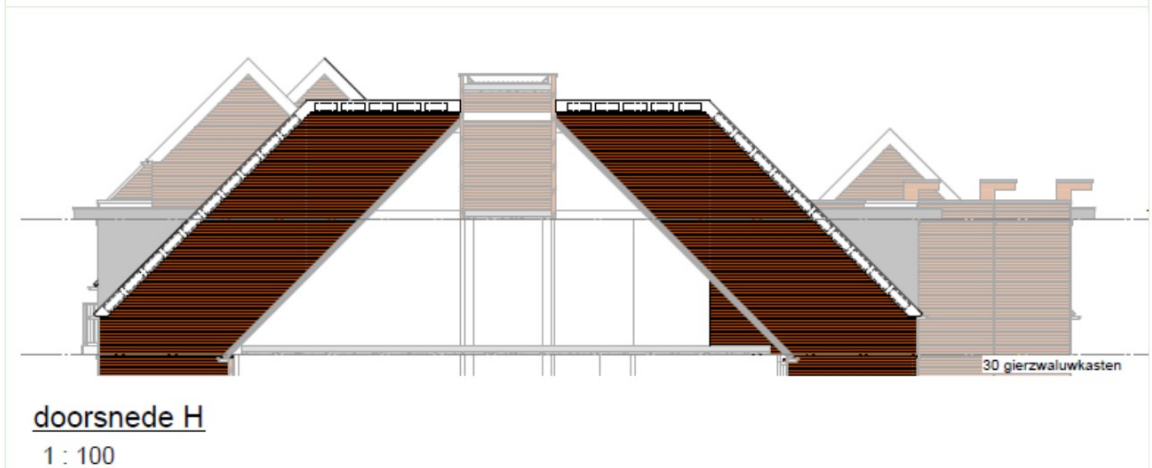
Detailaanzicht zuidelijk georiënteerde gevel, met nieuw te realiseren overstekken ten behoeve van fauna inbouwvoorzieningen
